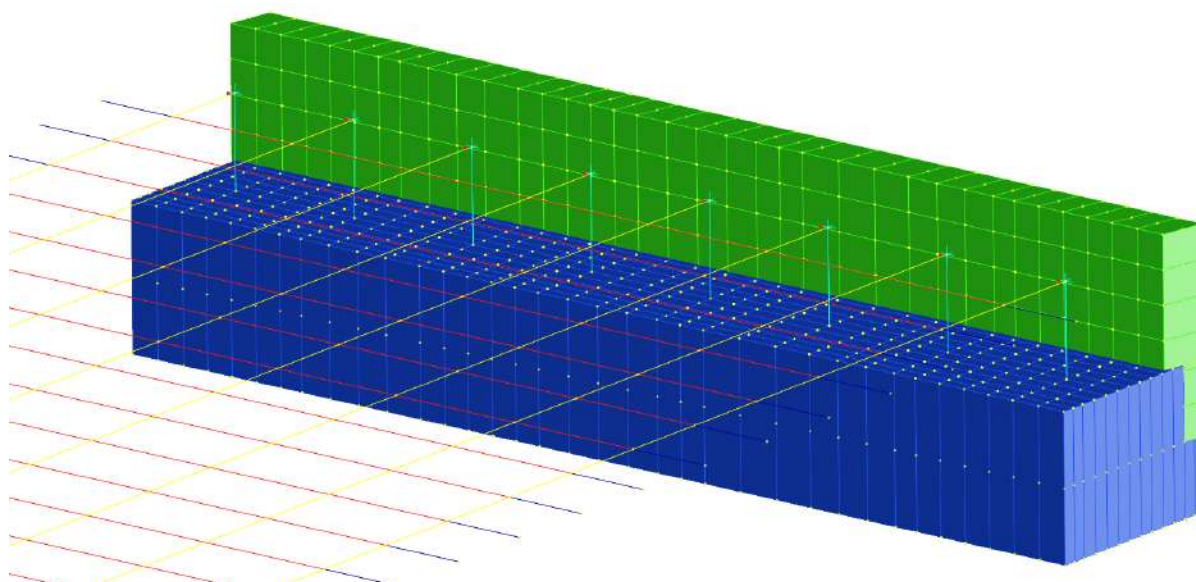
MODELLO FEM TRIDIMENSIONALE– VISTA ELEMENTI SPALLE
